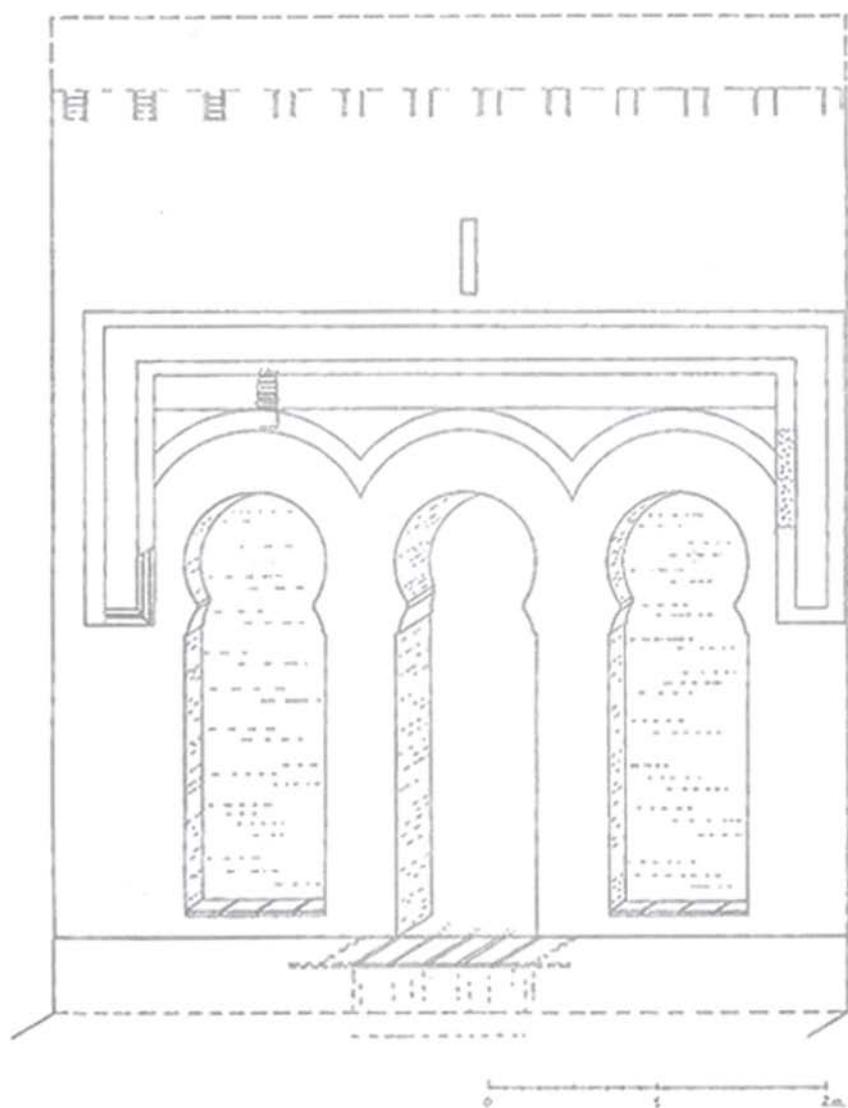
Ensayo de reconstrucción de las fachadas de la Capilla de Belén. 1:30.
